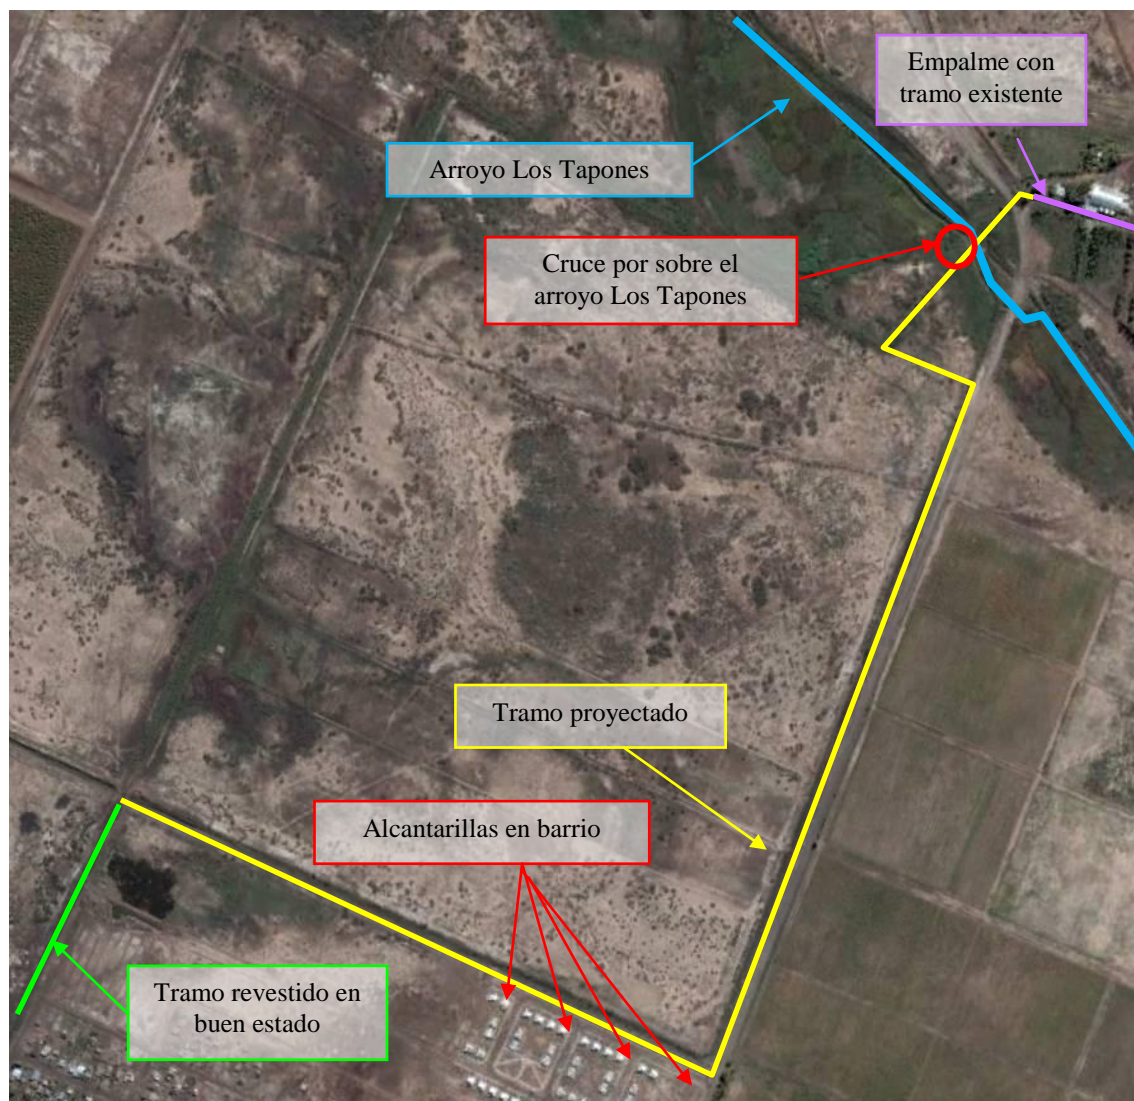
Ramo Guillemain. Nueva traza junto a calle Zapata.
